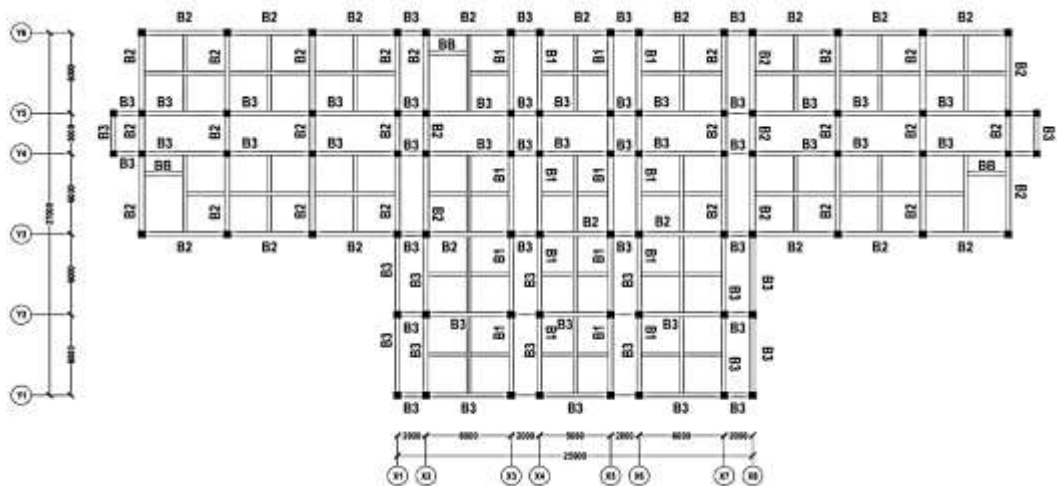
Denah Kolom Lantai 3 Gedung Balai Latihan Kerja (BLK)
